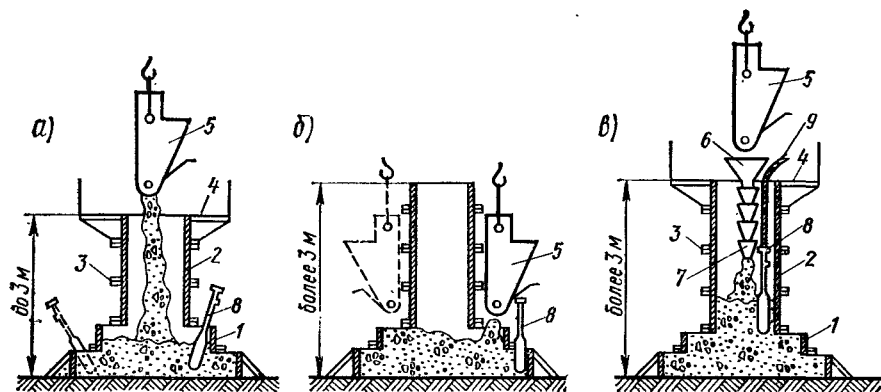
Бетонирование ступенчатых фундаментов:
